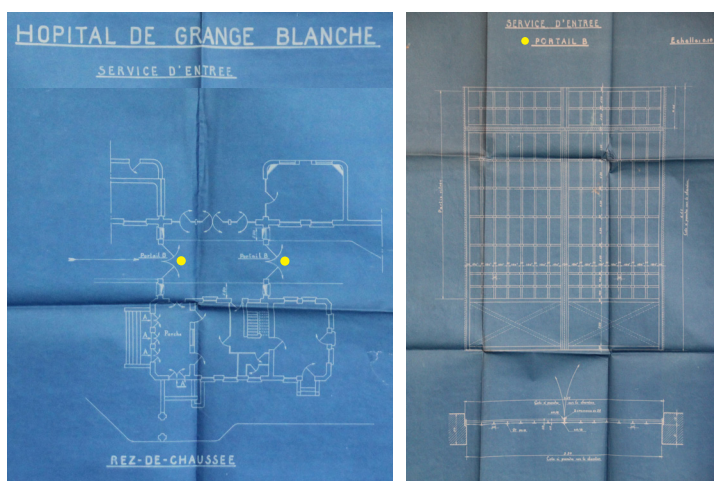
La descente à couvert du pavillon A (ancien bâtiment 8) de l'Hôpital Edouard Herriot, Service d'entrée, plan, et plan des grilles portail (type B - ferronneries), Archives Municipales, 484 WP 35, non datés.
